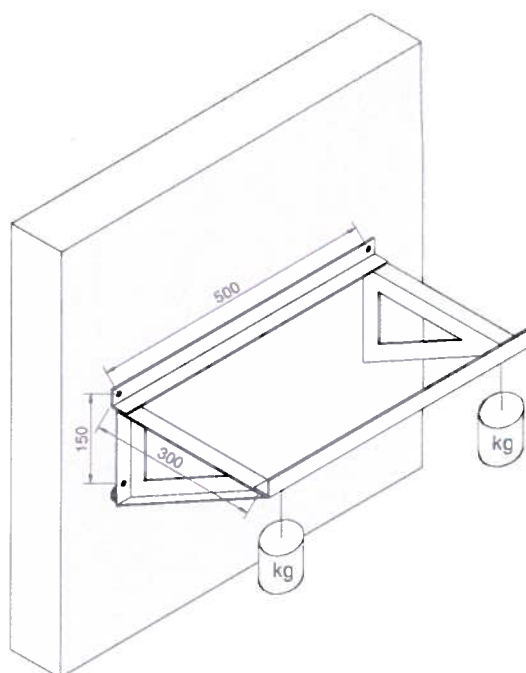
Esquema de ensaio para suspensão de cargas verticais excêntricas.
